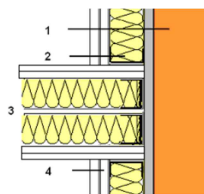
Encuentro de tabique autoportante con fachada en planta
